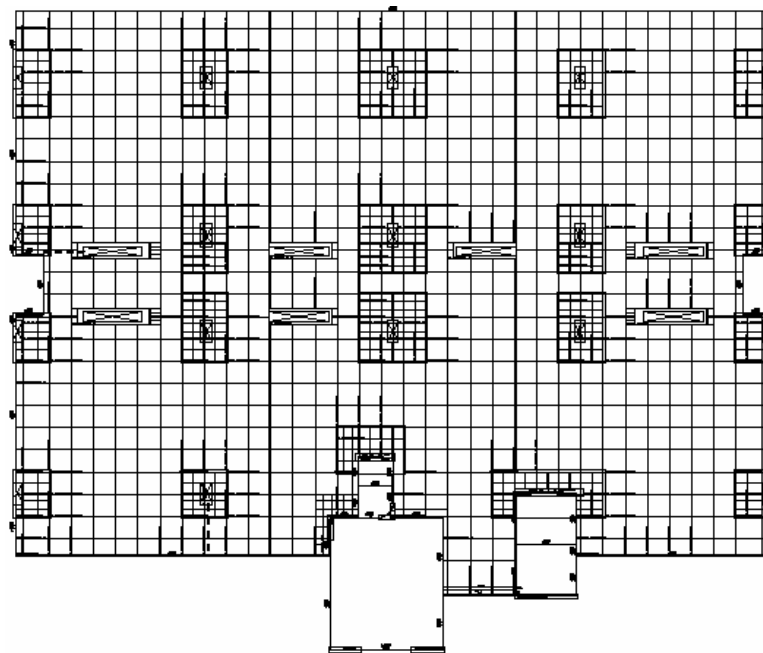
Malha da grelha para o pavimento tipo do primeiro exemplo.
